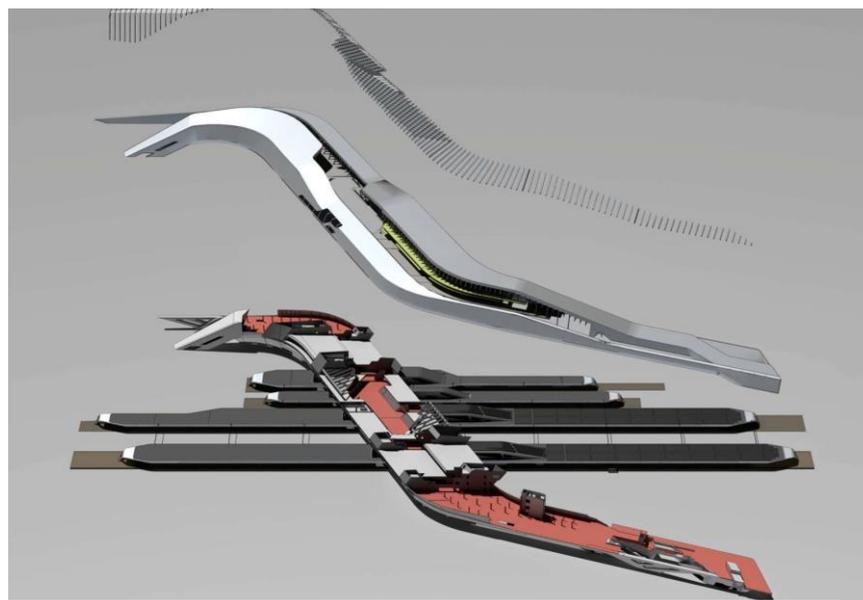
Axonometría estructural de la Estación Napoli Afragola.
